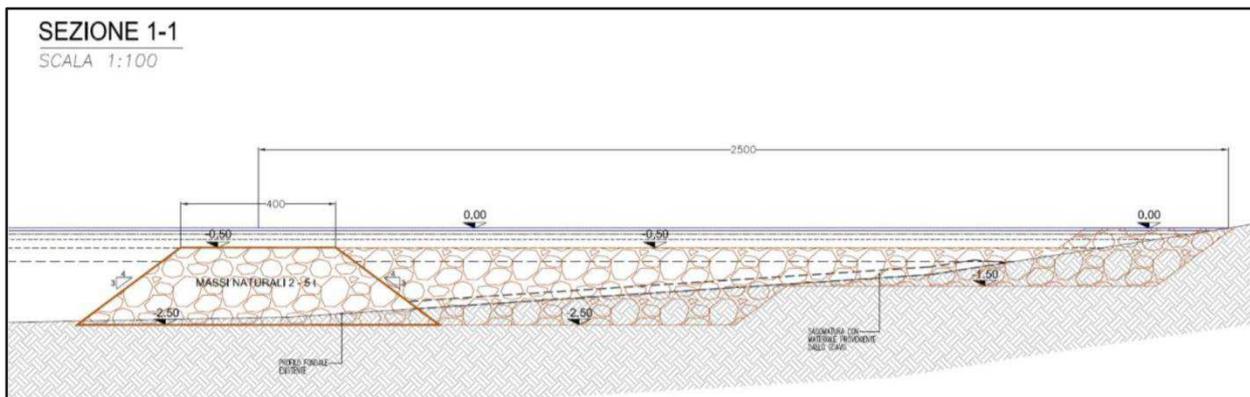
Sezione di intervento (all. 05A del progetto preliminare)
